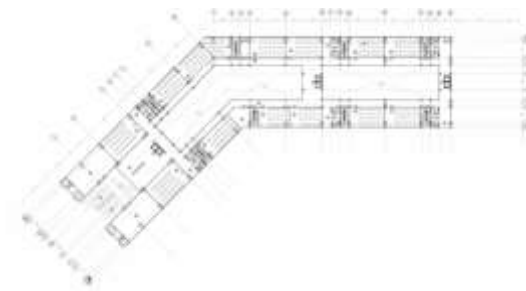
Denah lantai 4 Sekolah Tinggi Parwisata Semarang
